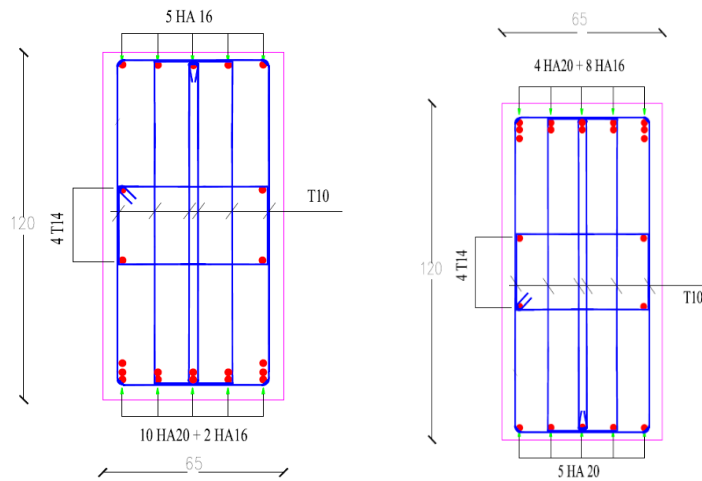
Schémas de ferrailage de la dalle du radier.
